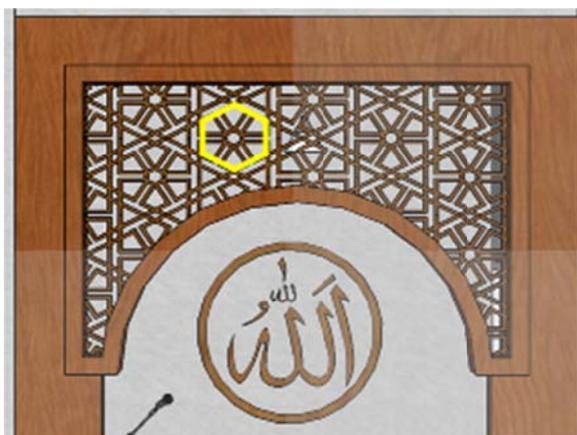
Desain Ruang Sholat Jamaah Wanita
